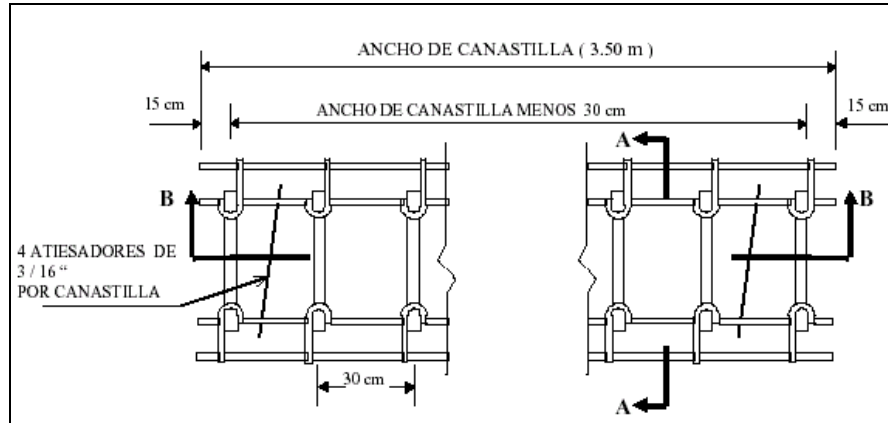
Canastilla de Pasadores. Vista en Planta
